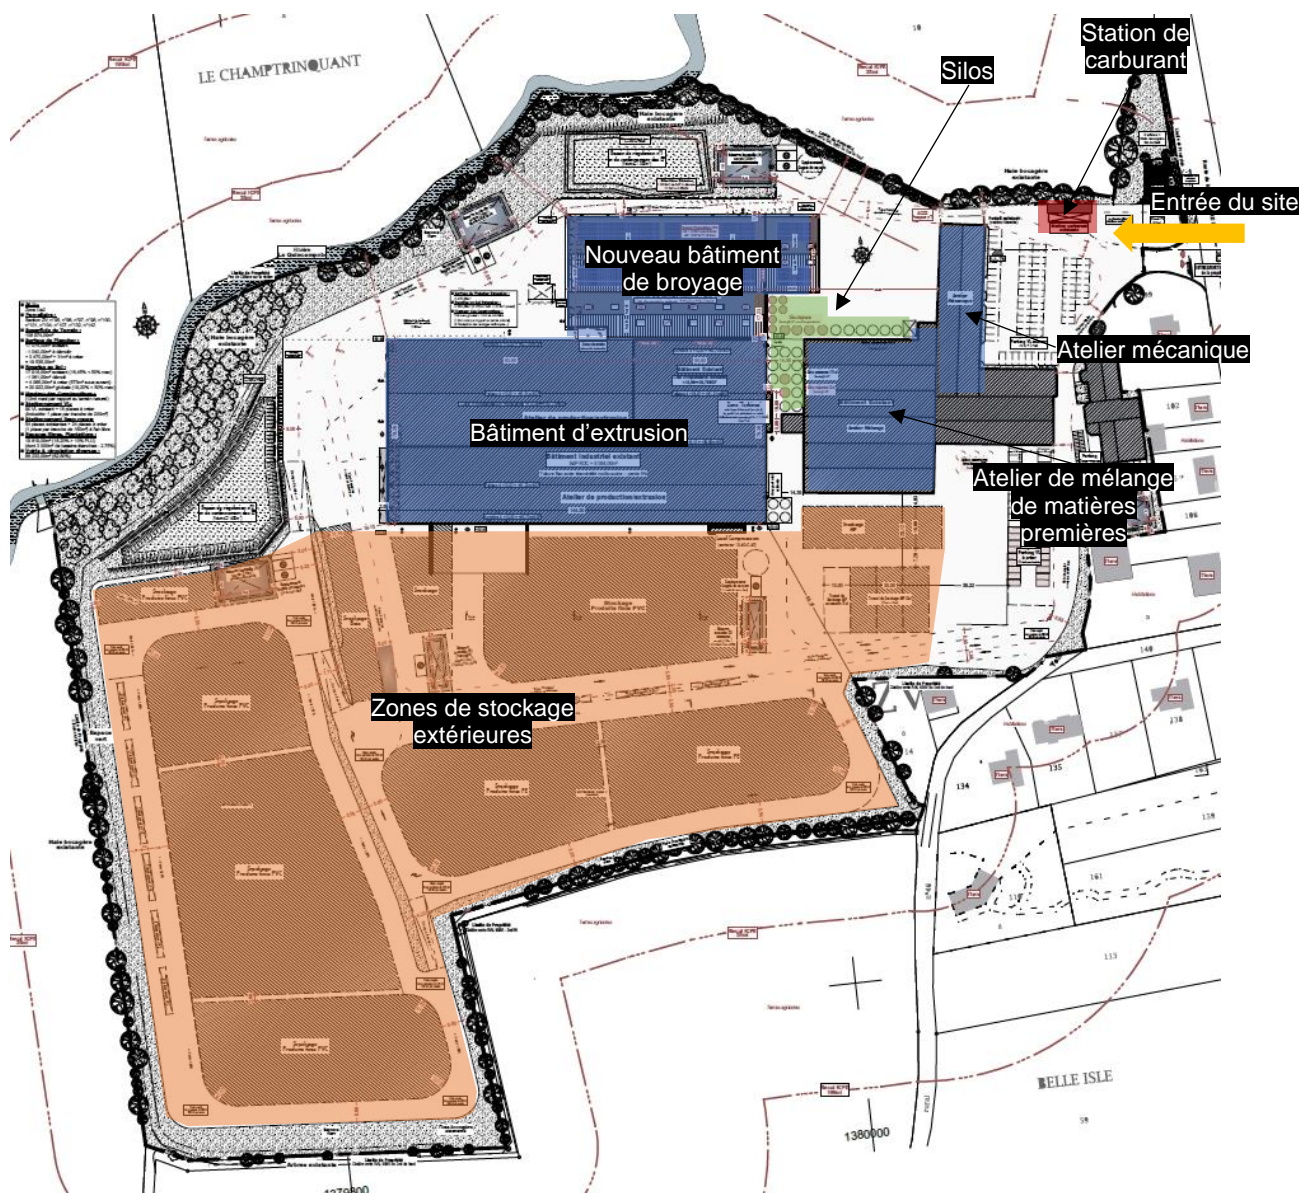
Plan d'ensemble du projet (Source : Nicot Architecte)
